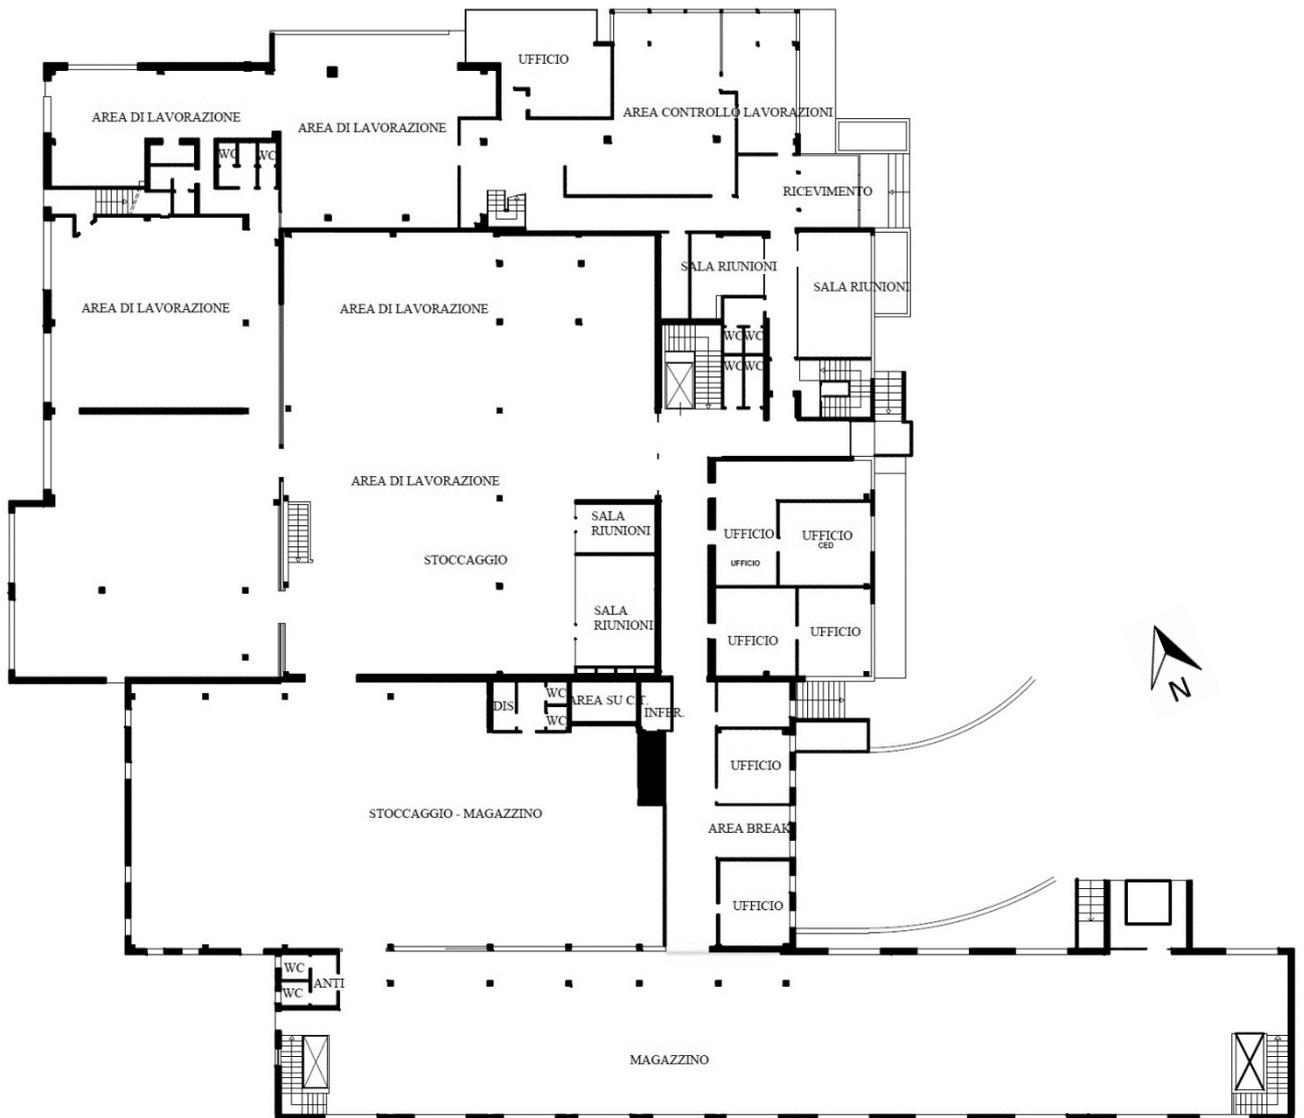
Pianta primo piano, scala 1:500. Fonte: Bottega Veneta
